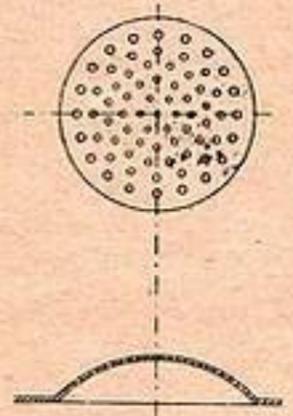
Coupe et plan d'une calotte sphérique diffusante en staff appliquée contre le plafond et percée de trous, d'autant plus gros qu'ils sont plus éloignés du centre.
